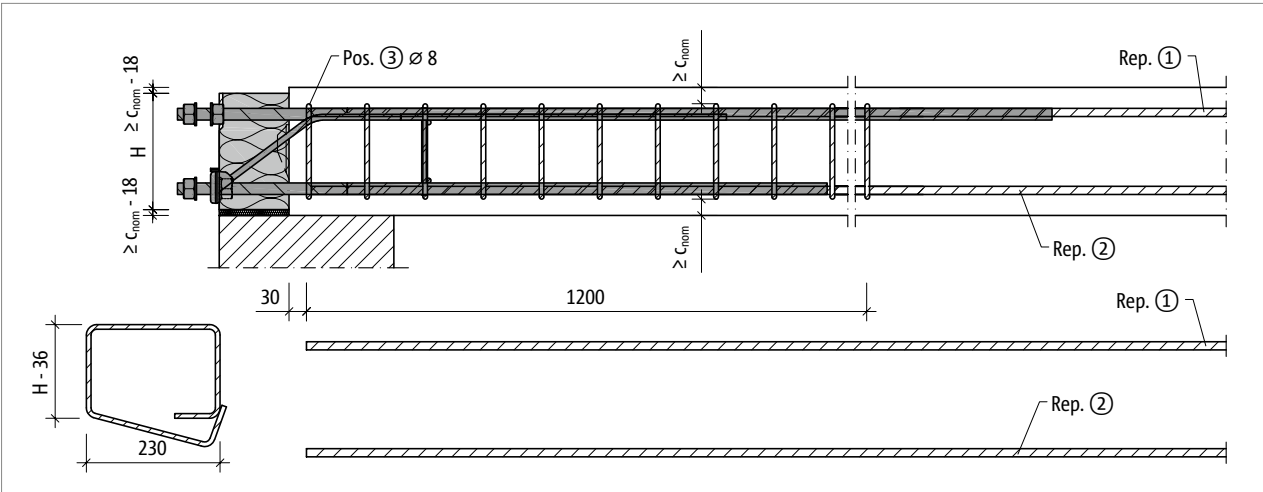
Schöck Isokorb® XT type SK-MM2 : armatures à prévoir par le client avec étrier de Ø 8 mm ; vue en coupe
